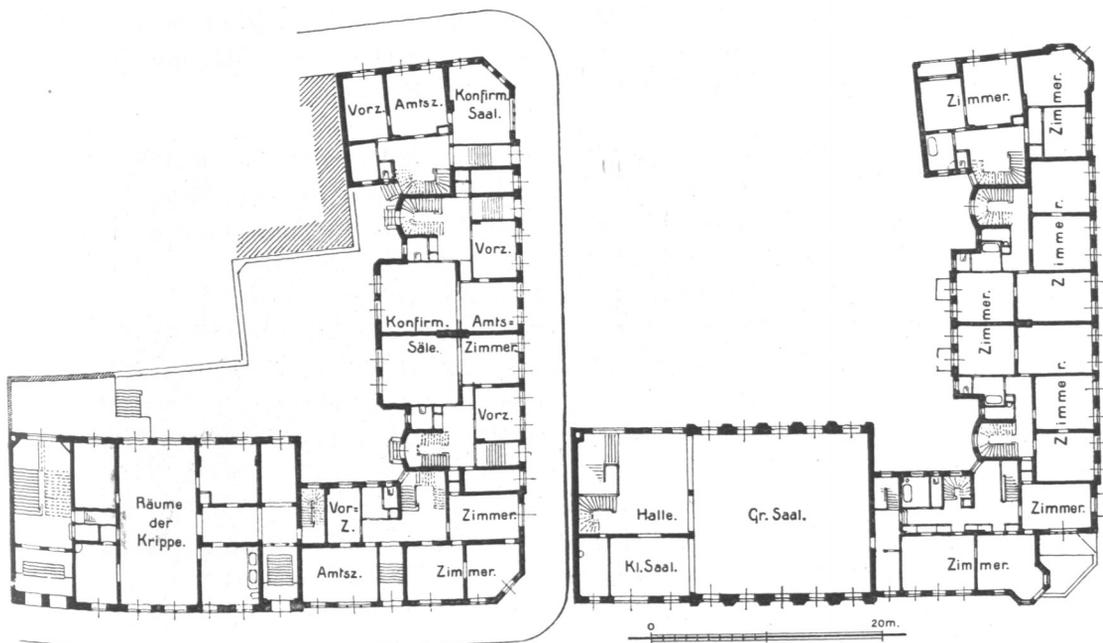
und 171. St.-Jacobi-Pfarrhof, Grundrisse.
